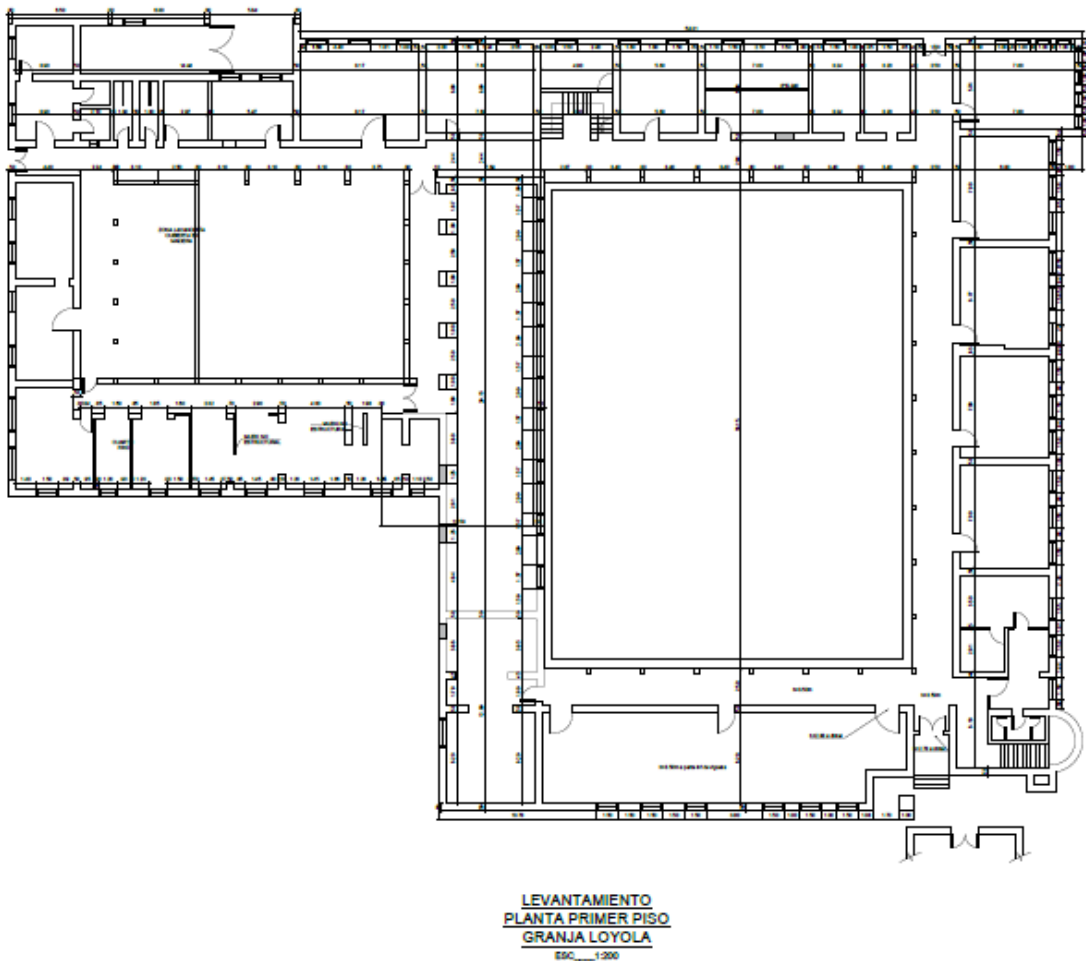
Levantamiento arquitectónico Planta Primer Piso.
